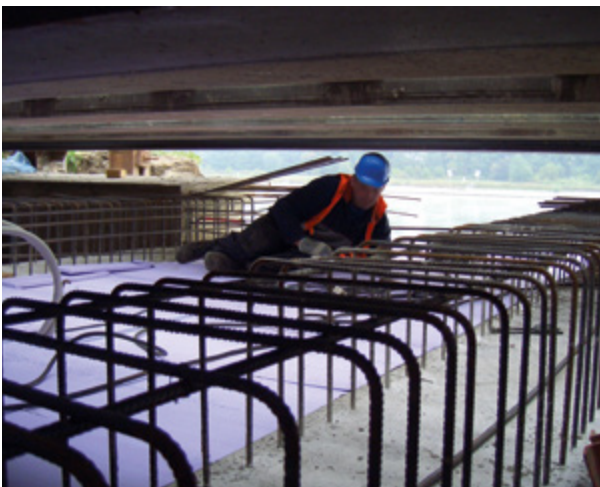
Bei unzureichendem Arbeitsraum kann die Tunneldecke nicht fachgerecht hergestellt werden und Betonieren, Oberflächenbehandlung und Abdichten können Anlass geben, die Hilfsbrücke zu betreten. Warnwesten sind geschlossen zu tragen.
